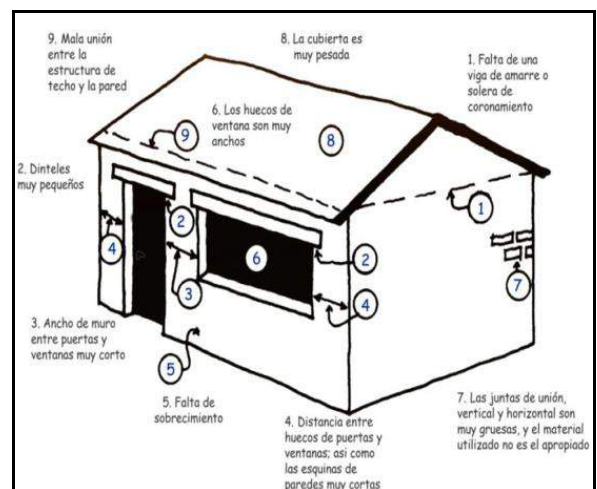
Principales fallas en el sistema constructivo de adobe, investigación de campo Proyecto TAISHIN
